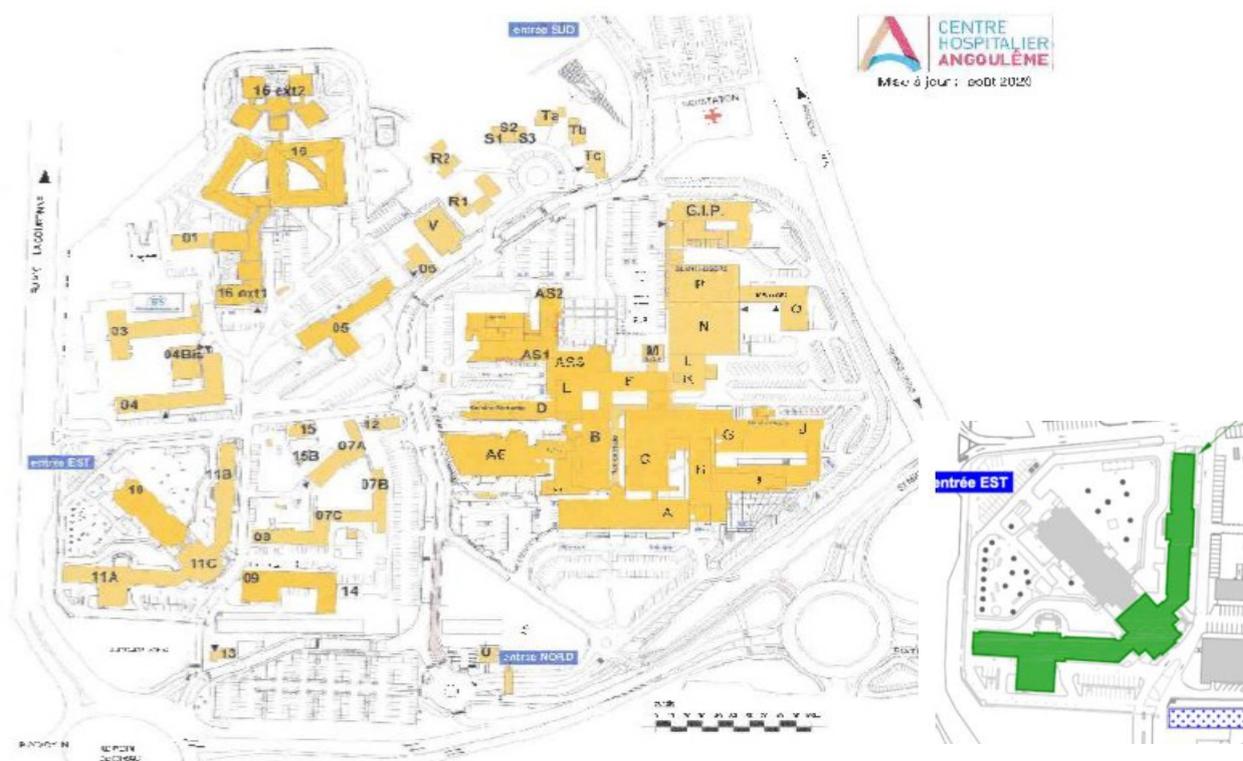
Plan de masse du centre hospitalier d'Angoulême – et zoom sur la zone de projet (en vert)
